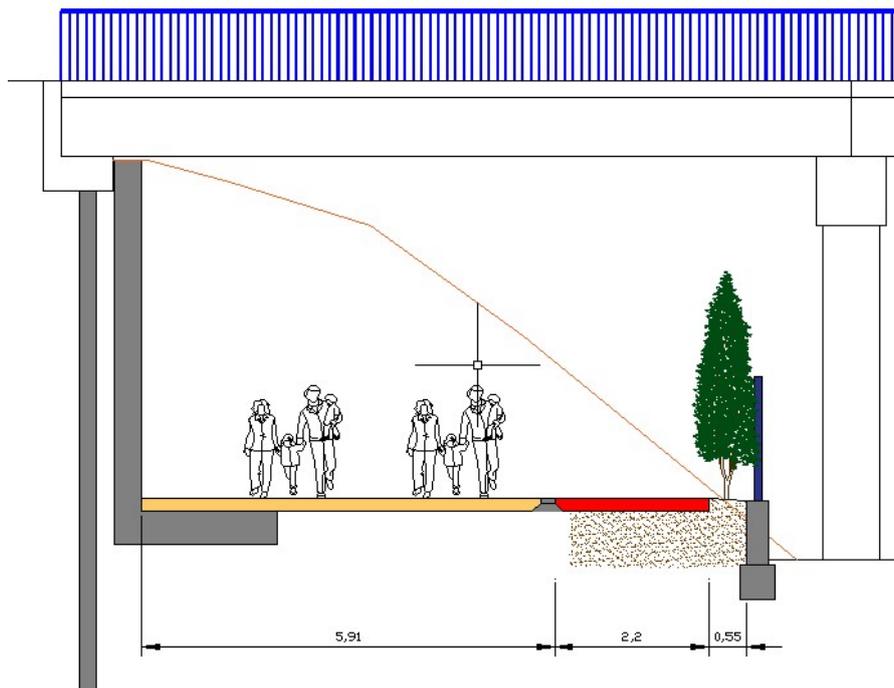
Sección tipo con la solución alternativa. Fuente: propia
